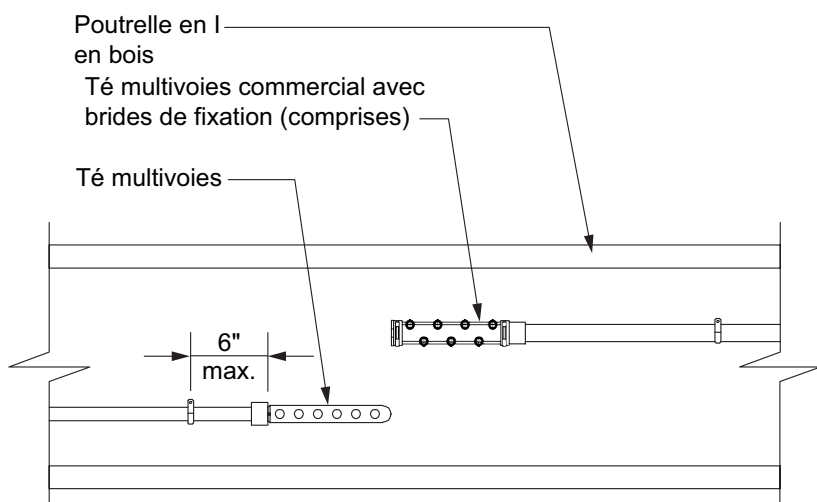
Support de tés multivoies sur des poutrelles de bois en I
